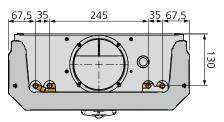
Dimensions ADRIATIC AWC Prisma, vue arrière du raccordement hydraulique
